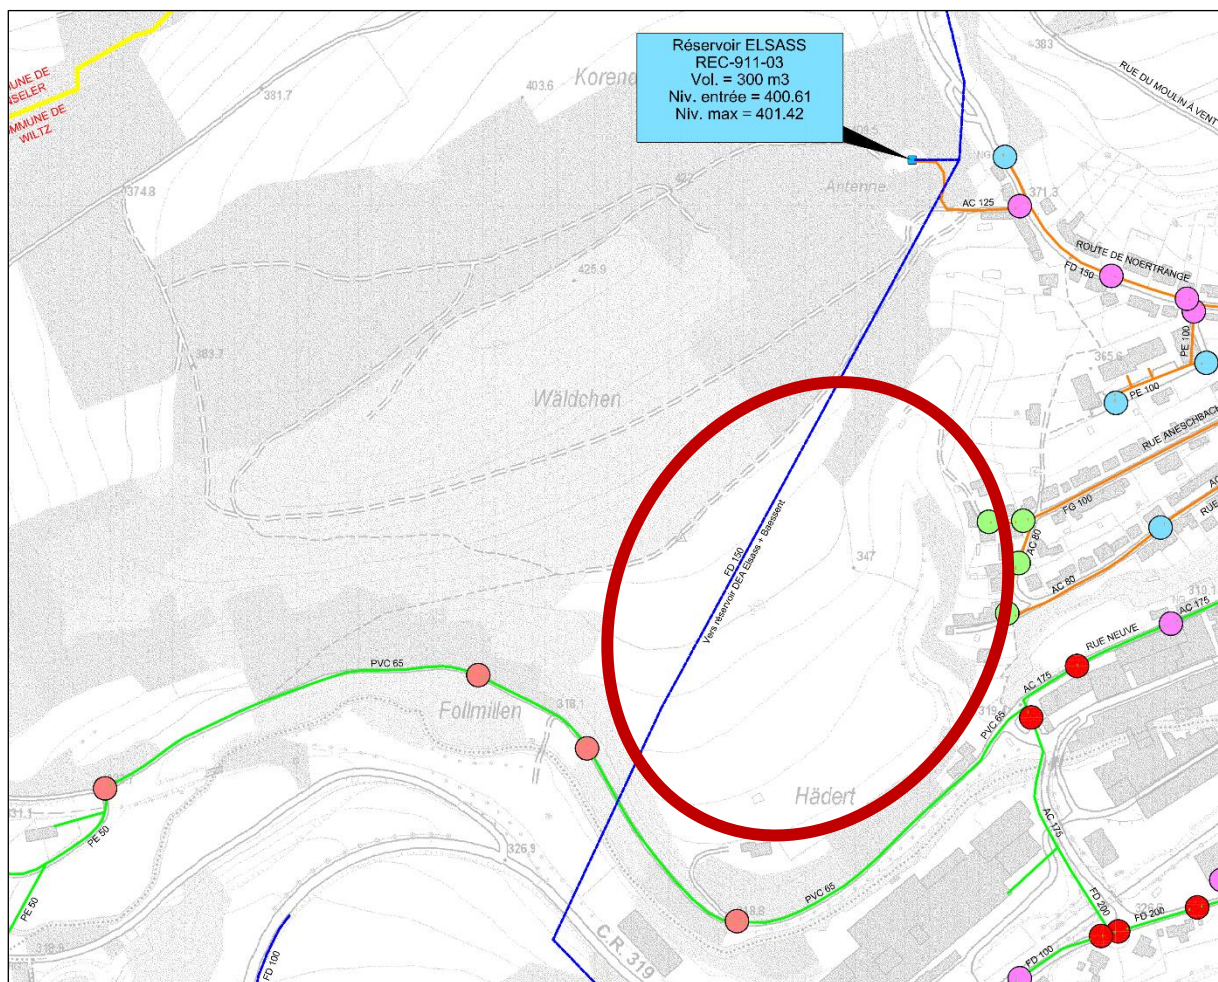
Auszug aus dem Trinkwasserplan der Stadt Wiltz im Bereich des Plangebietes „Heidert“ (rot) mit querender Transportleitung und nördlichem Trinkwasserreservoir. Quelle: SCHROEDER&ASS. 2011
